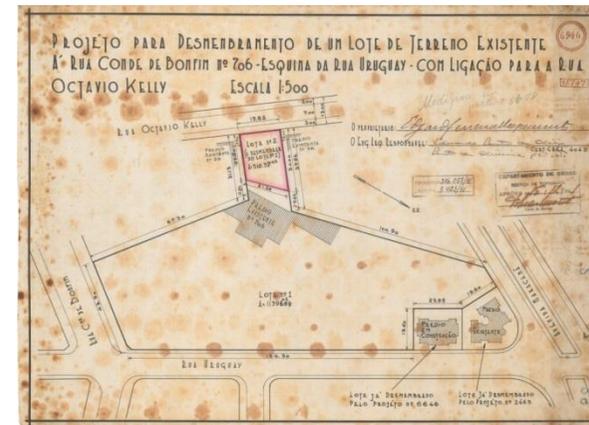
Os desmembramentos continuam e dão origem a novos lotes que, por sua vez, dão origem à outras construções
